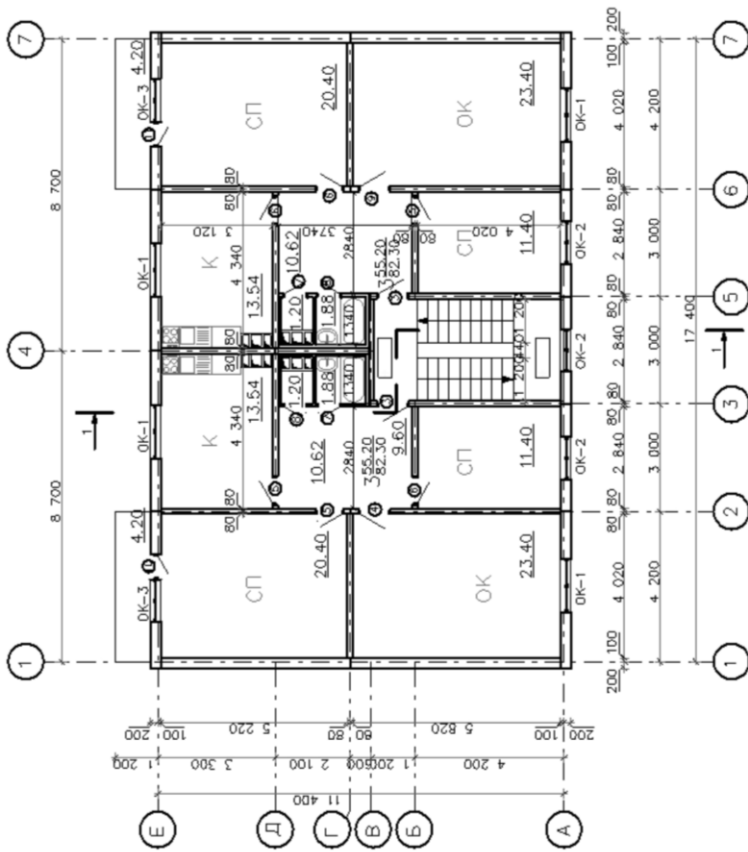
Пример оформления плана 2-го этажа жилого дома со стенами из панелей
